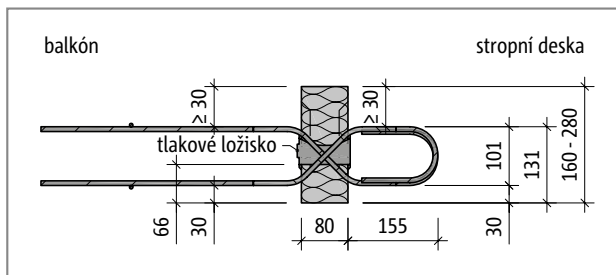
Schöck Isokorb® typ QP60M: Půdorys prvku
